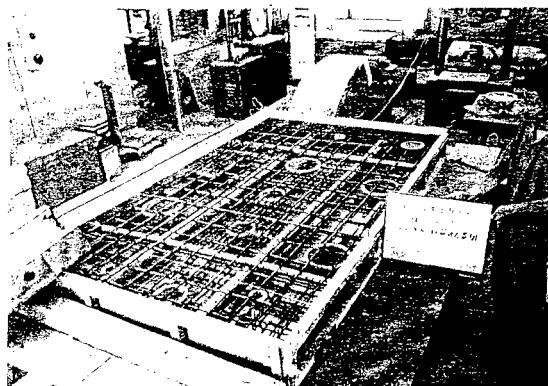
コンクリート床板模型の欠陥配置状況
